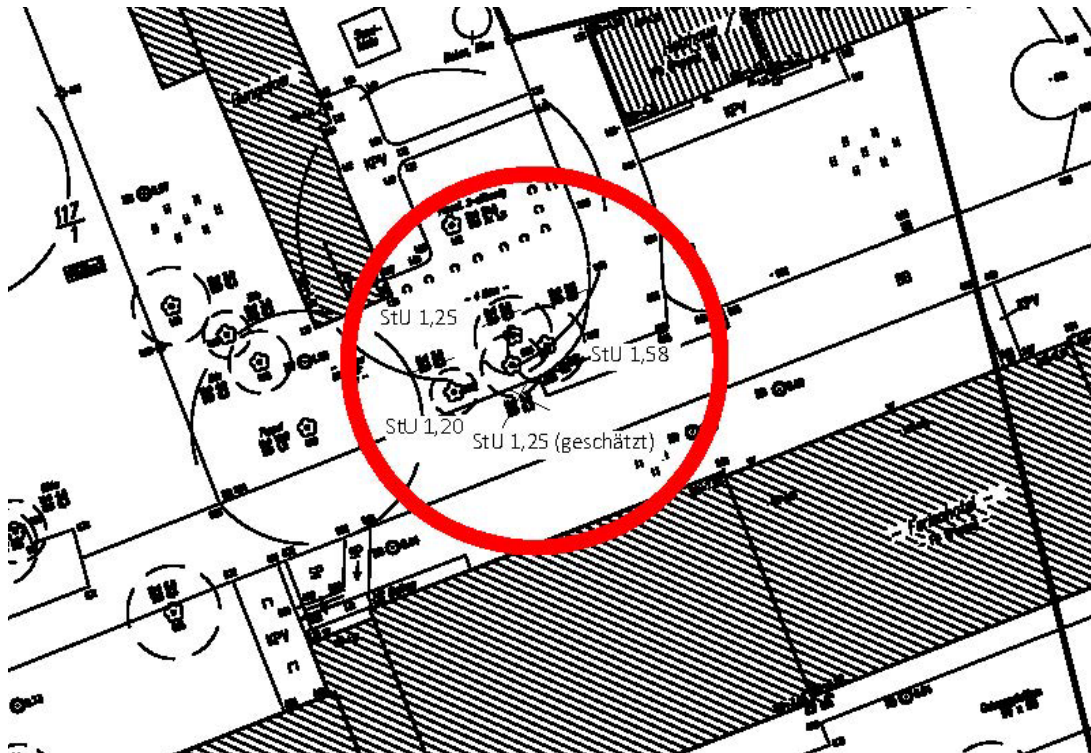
Standort der zu fällenden Bäume mit aktuellem Stammumfang
